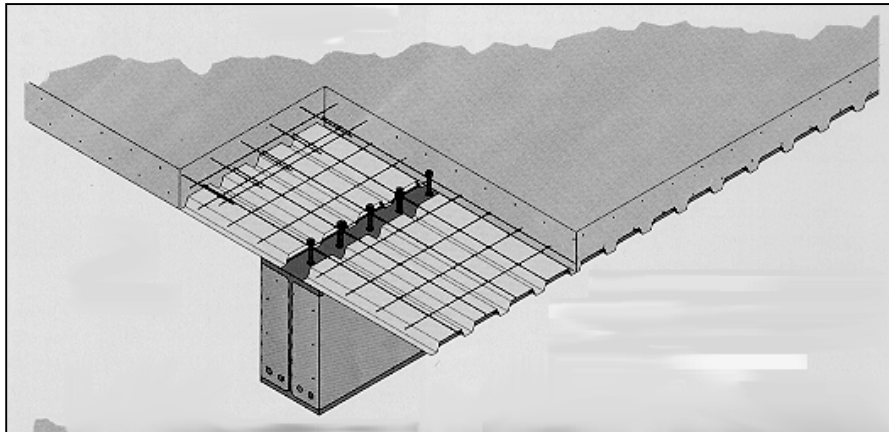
Geschößdeckendetail mit der Verbunddecke (Trapezblech mit Aufbeton), dem Stahlverbunddeckenträger und den Kopfbolzendübeln [1.1]
